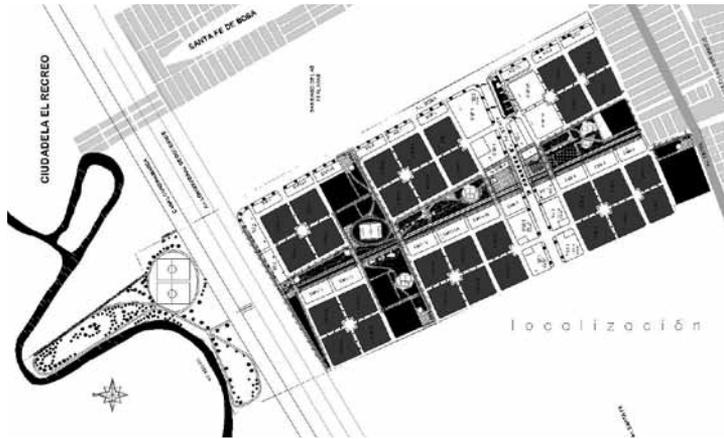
Planta de localización del proyecto en la Ciudadela El Recreo.
